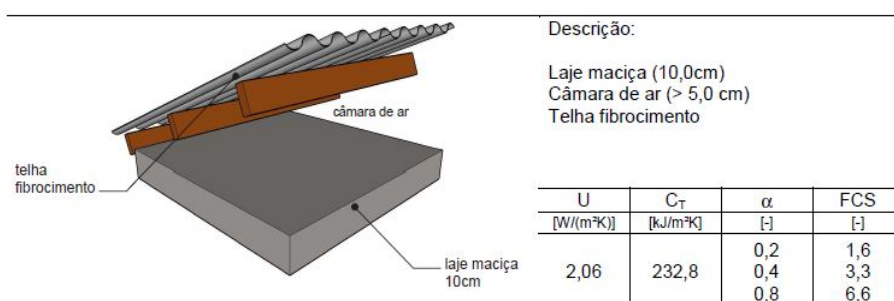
Telhado de fibrocimento com laje maciça (LabEEE 2010)
